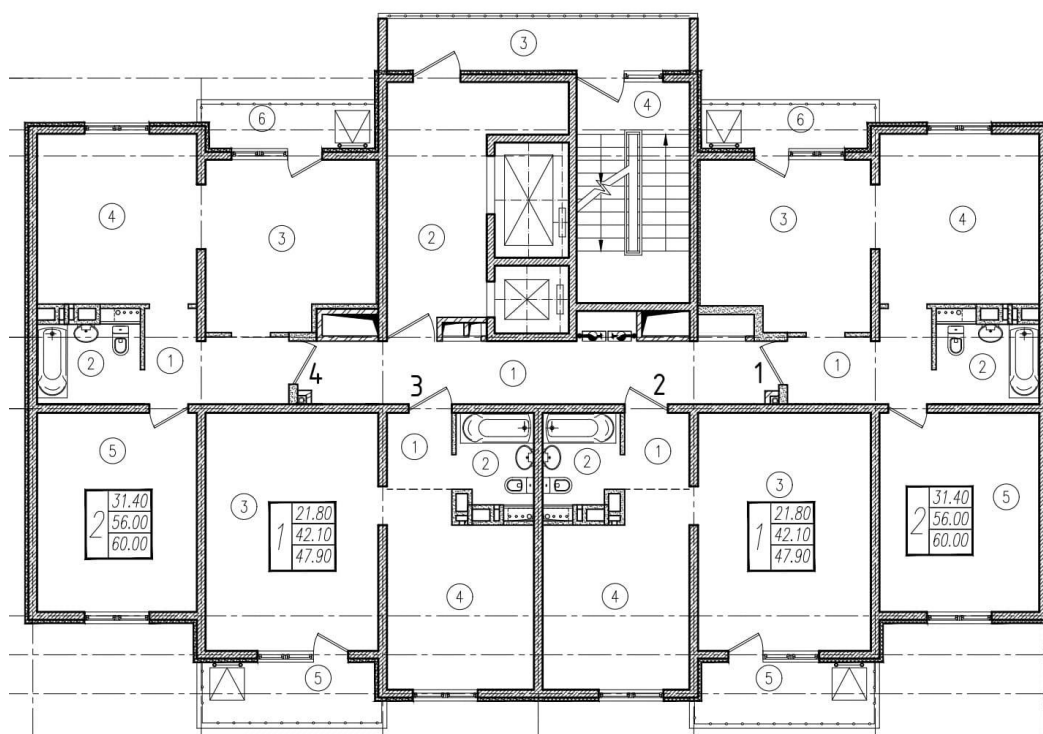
План 2-5-ого этажей 6 литеры ЖК «Горный квартал»
